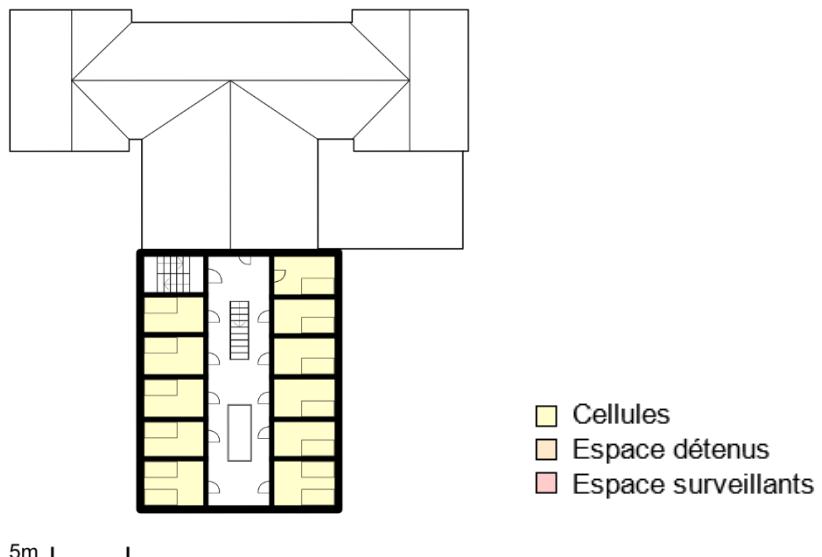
Plan du 3^{ème} étage du bâtiment 4
